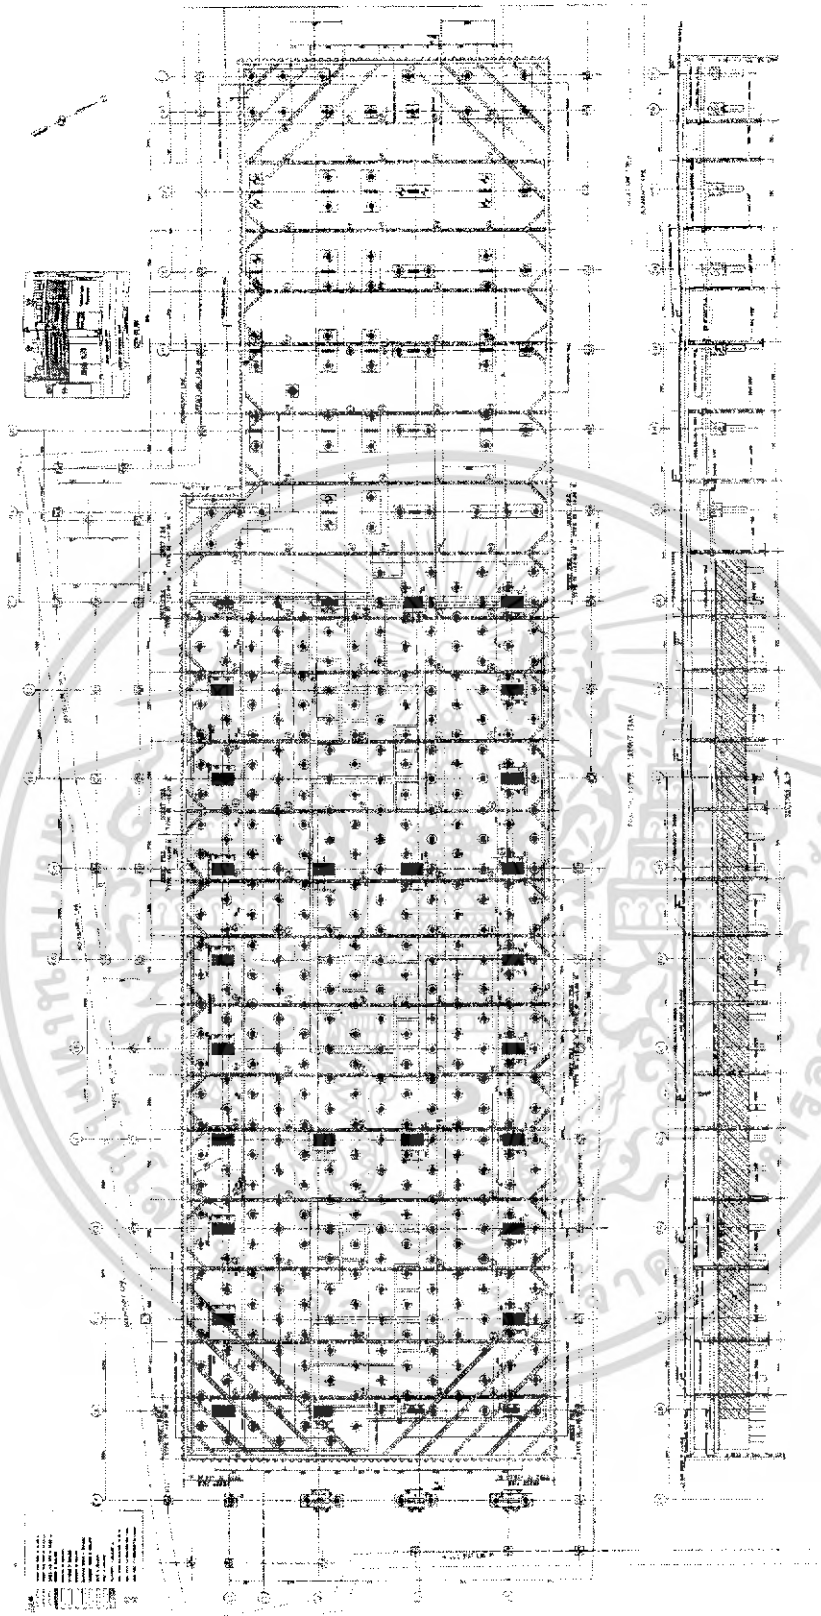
แสดง Bracing Layer 1 Plan ของโครงการ 340 Keys Hotel
